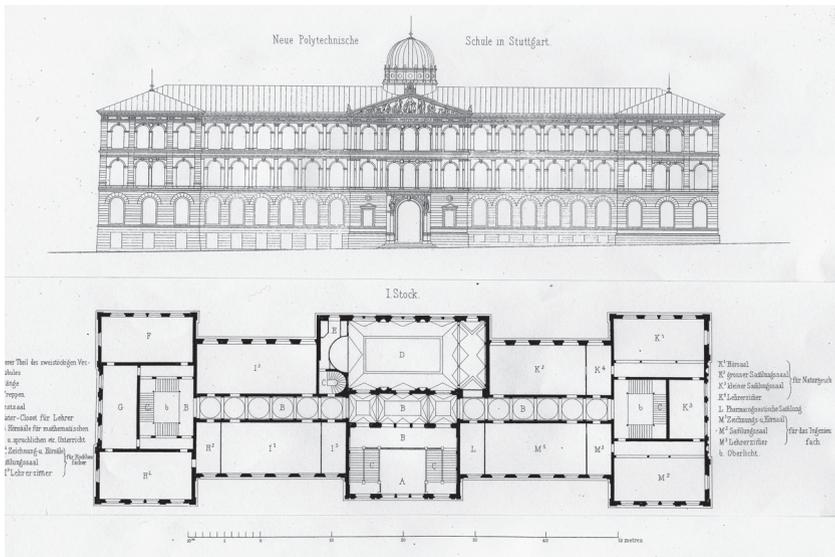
Neubau der Polytechnischen Schule 1864, Aufriss und Grundriss des 1. Stockwerks.
